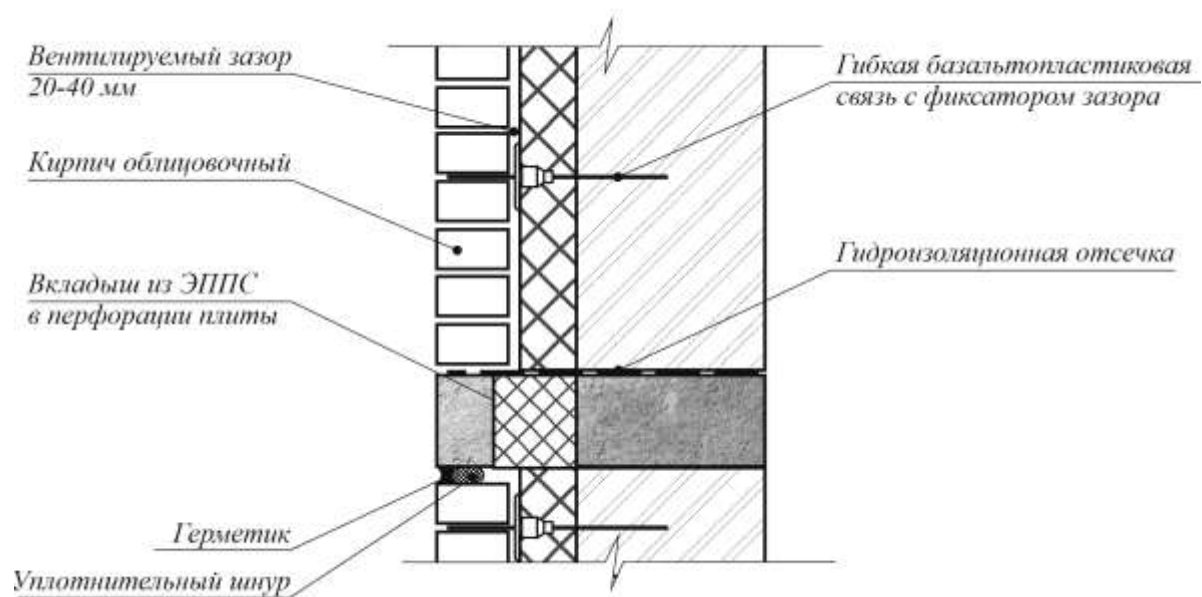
Узел опирания облицовочного слоя на монолитную железобетонную плиту перекрытия с устройством теплоизоляционного вкладыша в перфорации плиты
